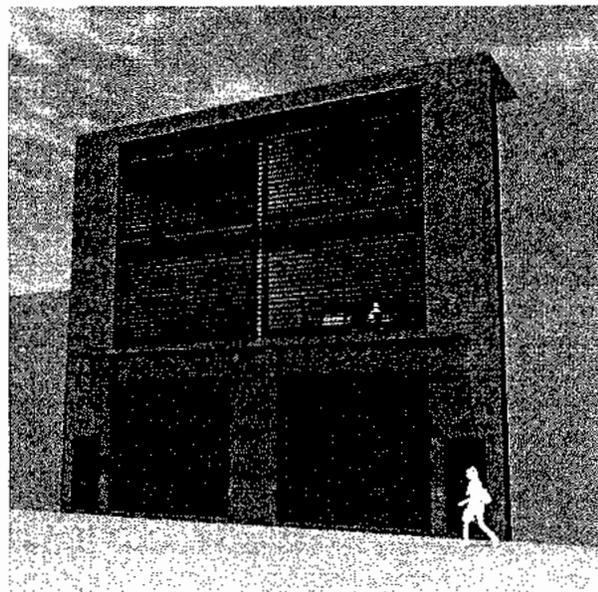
Propuesta de uso comercial o servicios en planta baja.
